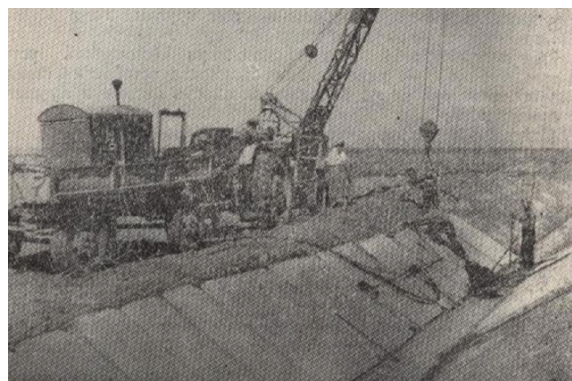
Installation de plaques de revêtement sur le canal Zhanadarya de 1957.
